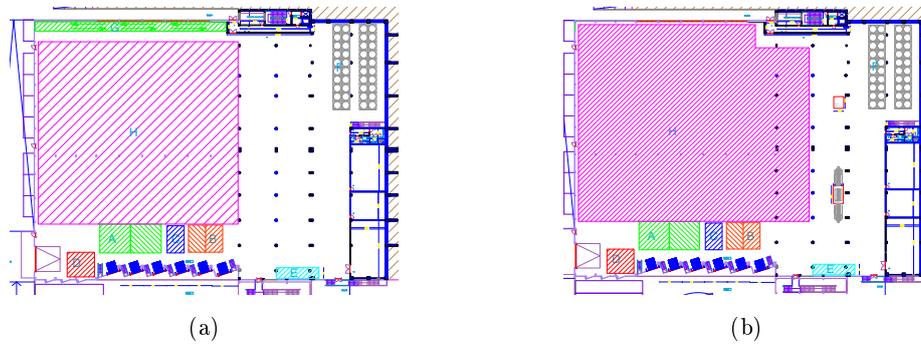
Planta do armazém com a incorporação de áreas funcionais e expansão de área de estantes
